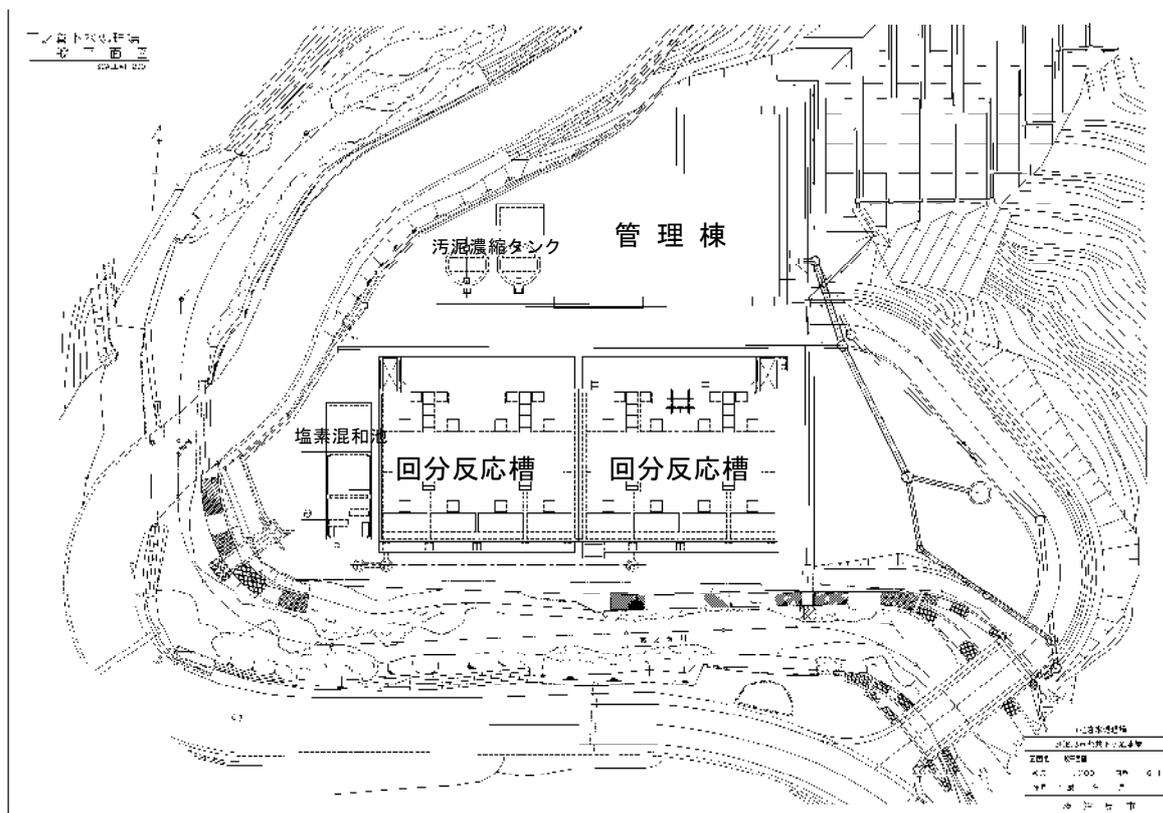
市之倉下水処理場の一般平面図（上図内の施設はすべて既設）
